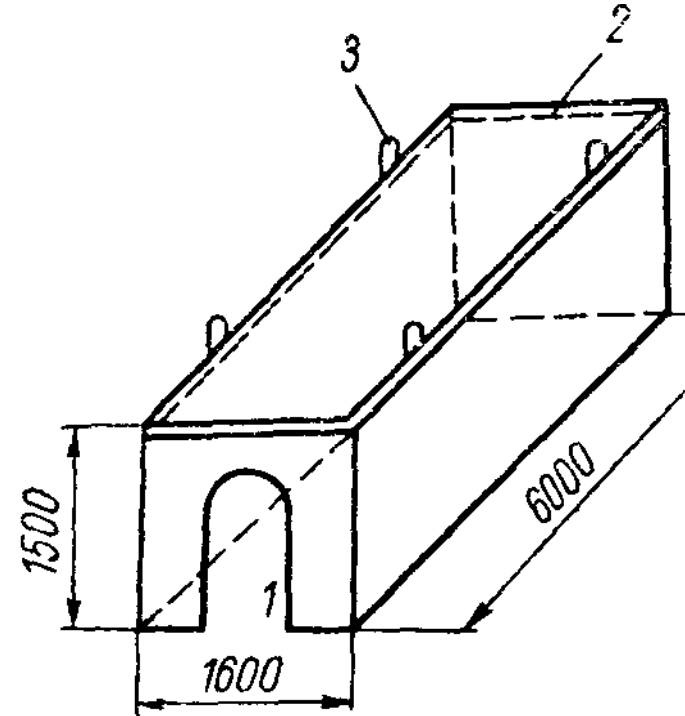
Металлический короб для укладки труб в водонасыщенных грунтах
